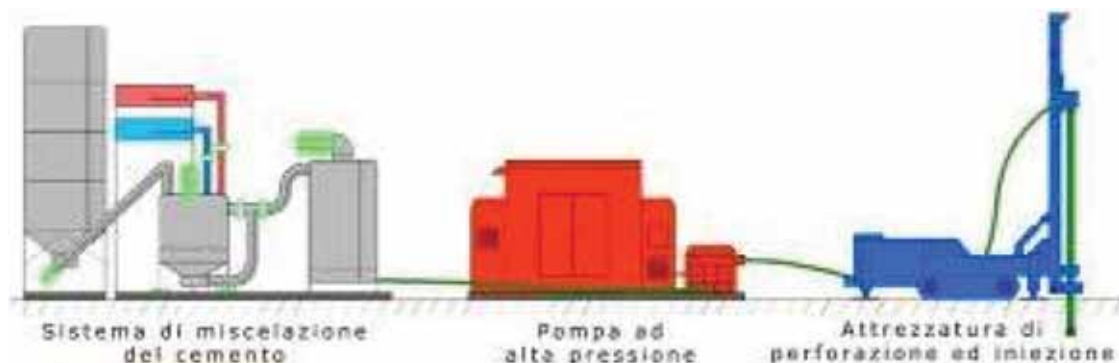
Schema di cantierizzazione per trattamenti colonnari (Jet Grouting)
